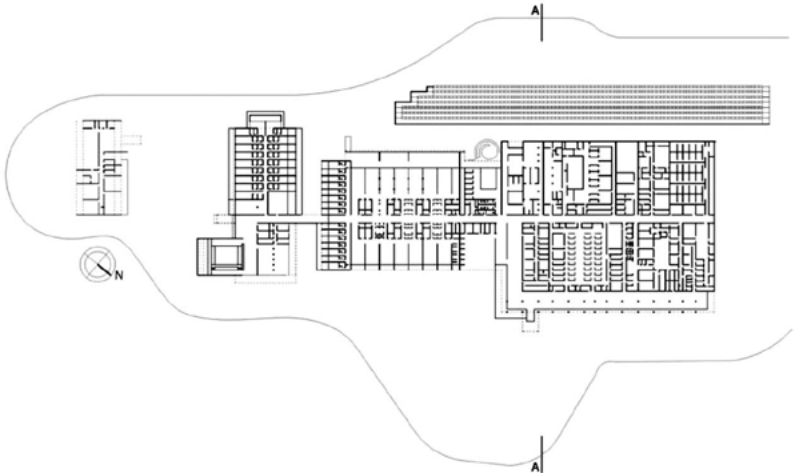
Planta baixa do Hospital Sarah Kubitschek, Salvador, Bahia
